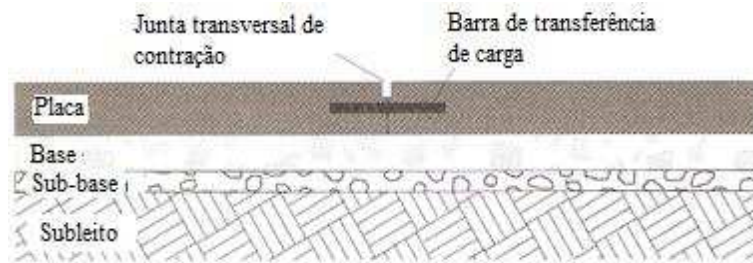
Seção transversal representativa de uma placa do pavimento de concreto simples (BALBO, 2009).
